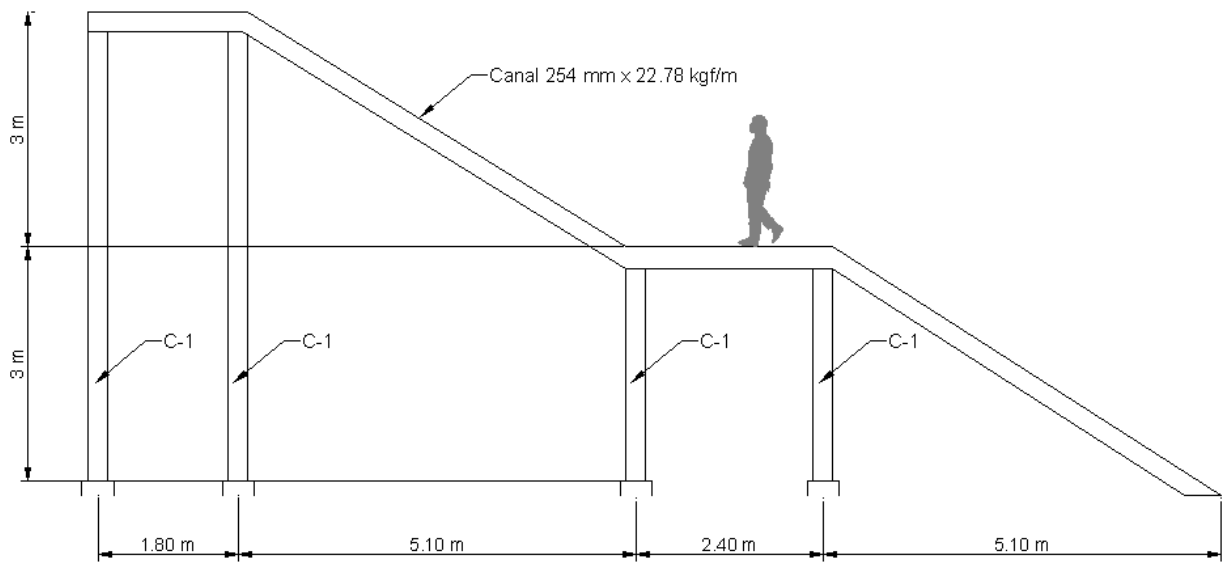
Detalle de escaleras de acceso al puente peatonal tipo (vista lateral)
